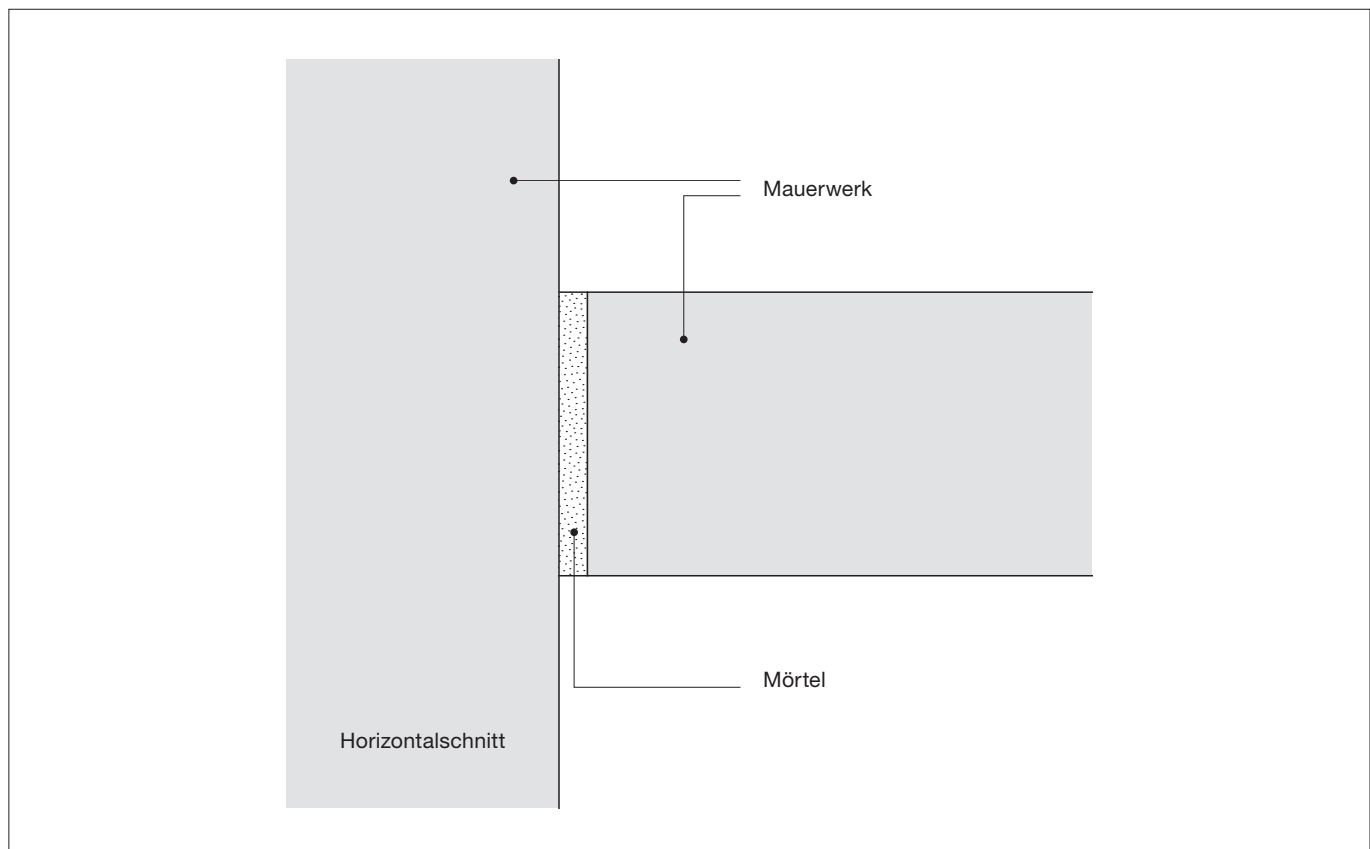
Stumpfstoßanschluss mit vollfugiger Vermörtelung, tragende oder nichttragende Porenbeton-Mauerwerkswände, zulässig auch für Brandwände
